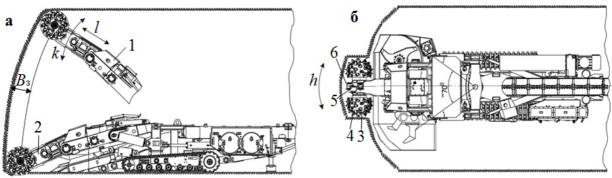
Проходческий комбайн избирательного действия в работе: а — вид сбоку при зарубке; б — вид сверху после зарубки
